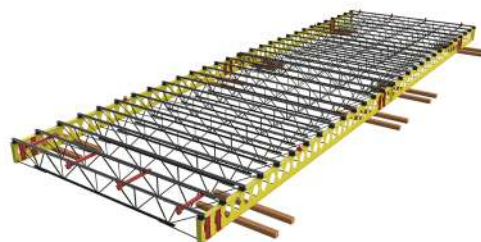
B - Encaixe das treliças com abertura permitida em cálculo
